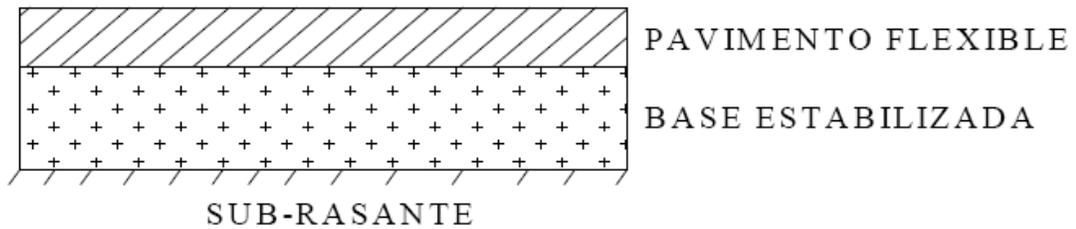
Sección transversal típica de un pavimento semi- rígido (Tipo 3).
